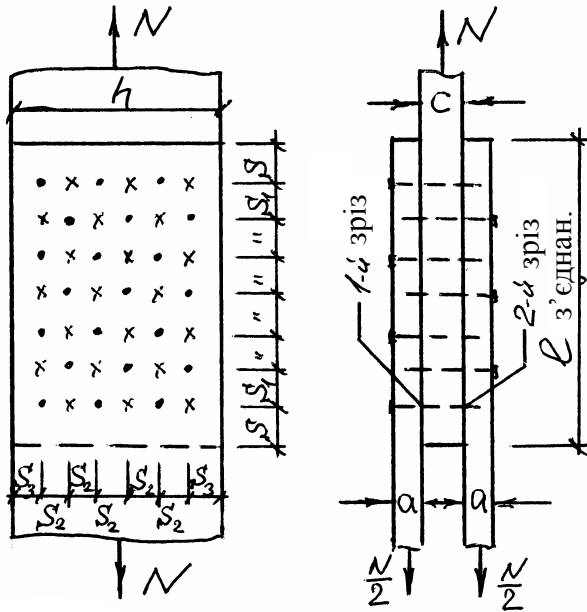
До розрахунку розтягнутого з'єднання на цвяхах
